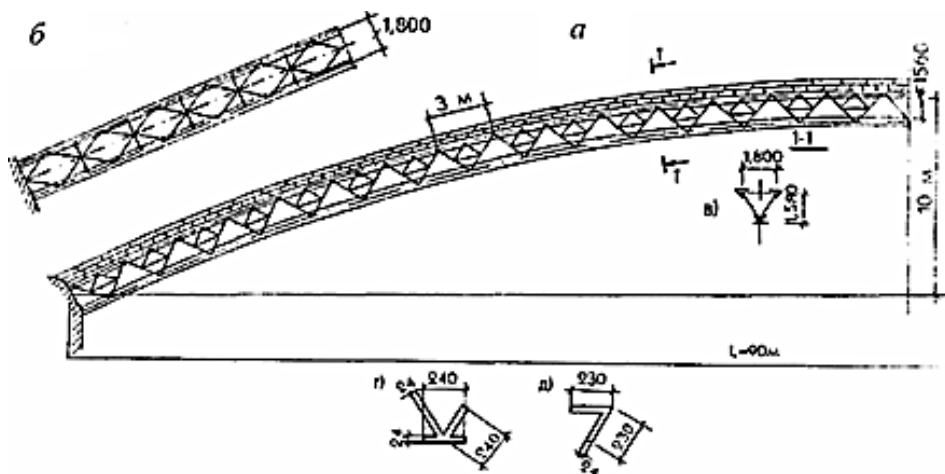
а – общий вид арки; б – решетка верхнего пояса;
